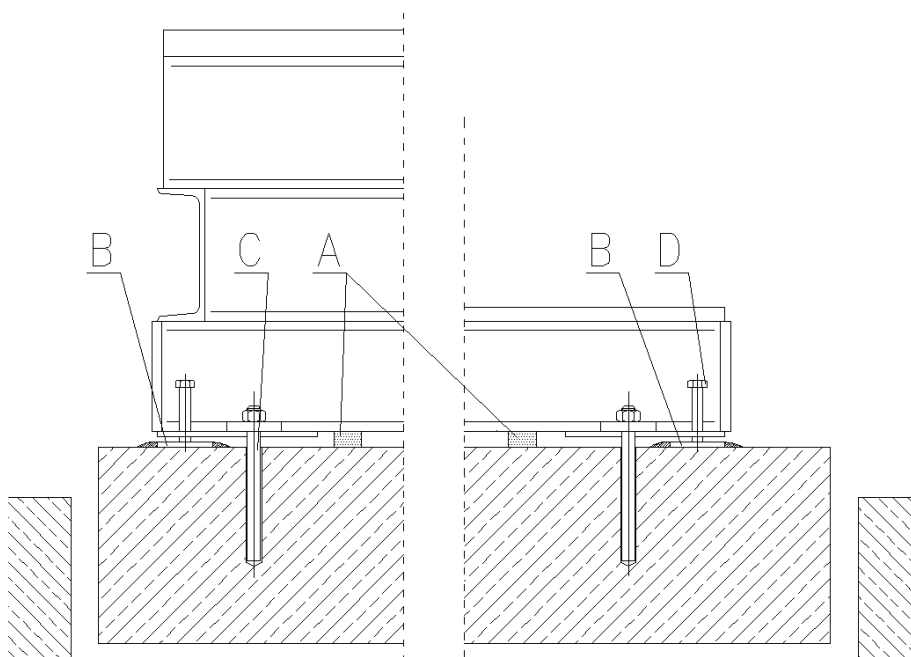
Wypełnienie zaprawą betonową obrzeża i wnętrza płyty fundamentowej
